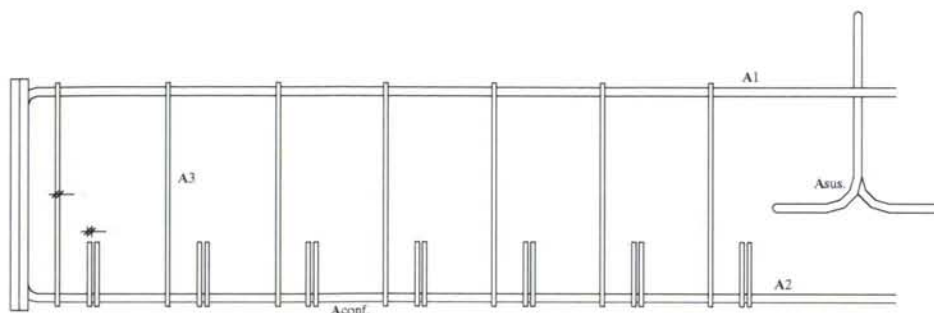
Alzado de la armadura de las vigas
